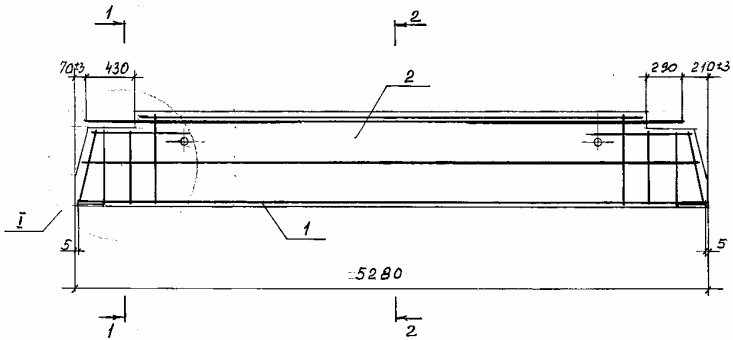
Армирование ригеля: 1 – нижняя рабочая арматура ригеля; 2 – пространственный каркас ригеля
